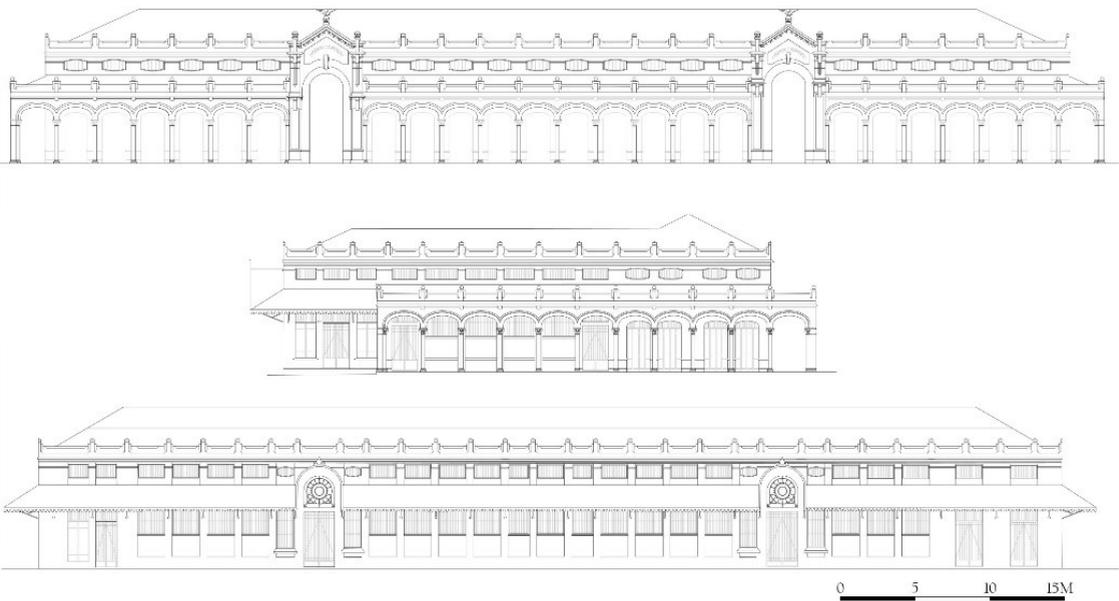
Fachadas realizadas digitalmente a partir de la planimetría hallada del edificio de mercado de Rodríguez. Arriba, fachada principal Este; siguiente, fachada lateral Sur; abajo, fachada posterior Oeste frente al río Sinú. Elaboración A. Benitez-Calle, M. Leserri. (2019).
